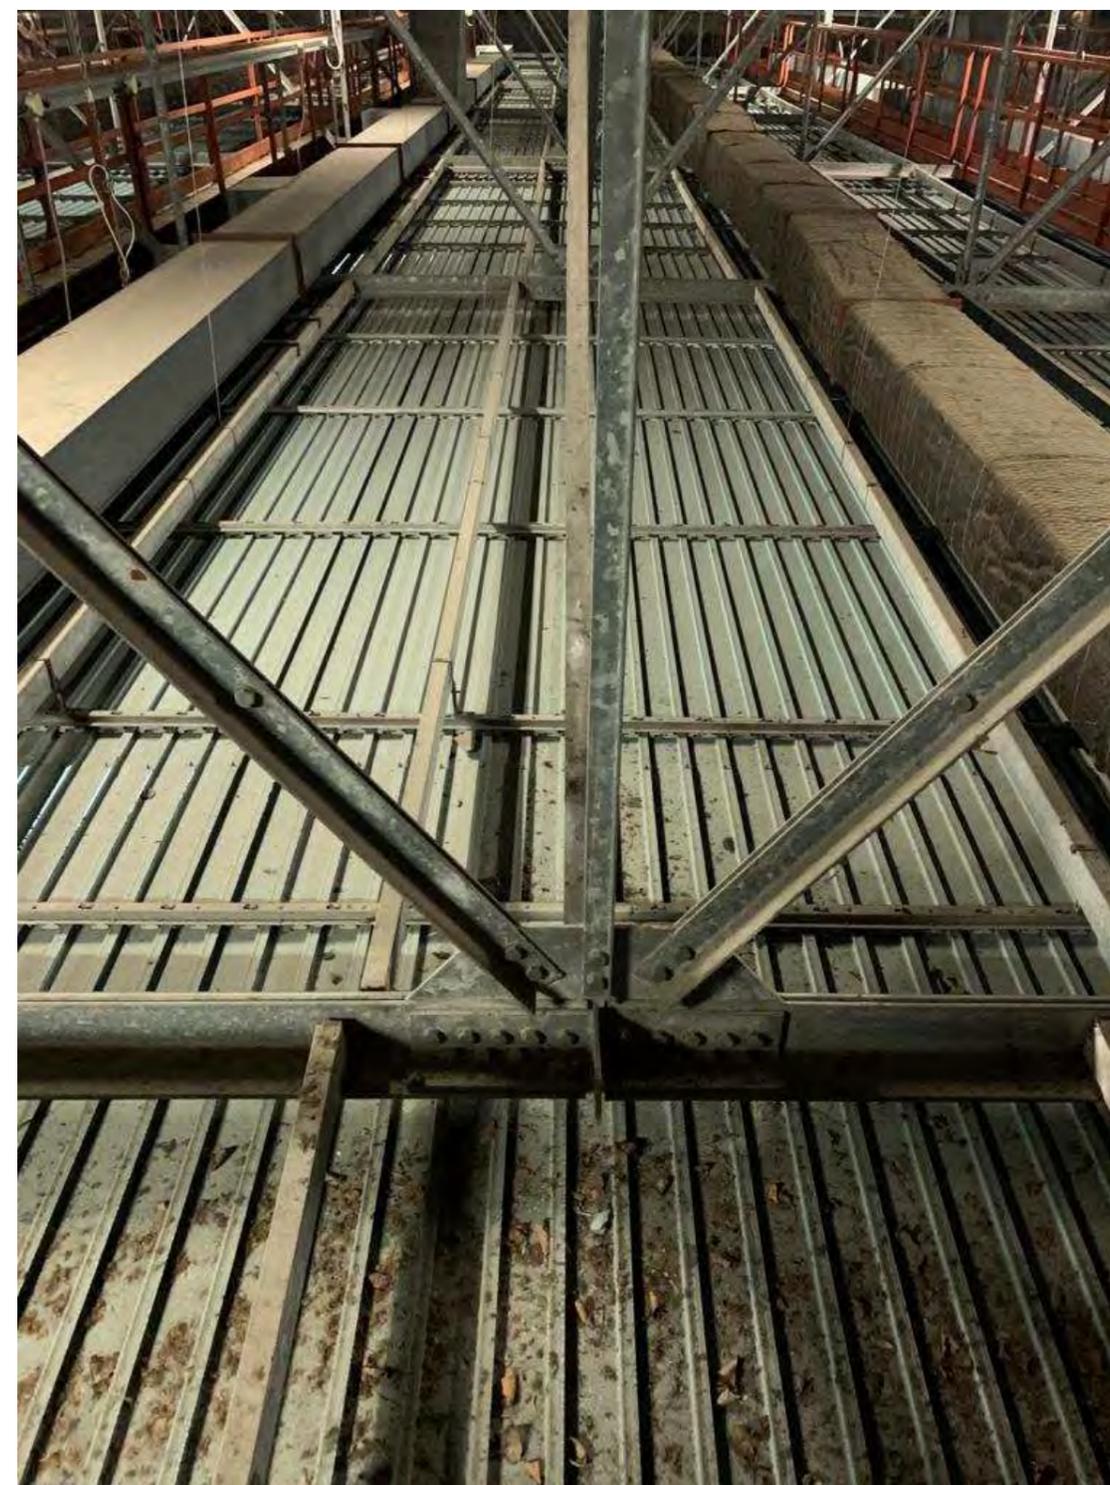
Tubolari del telaio di sostegno del controsoffitto in lamiera in appoggio sul lato del profilo al L accoppiato del tirante della reticolare
